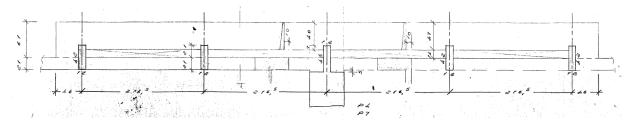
Planta dos brises retirada do projeto original de estruturas.
